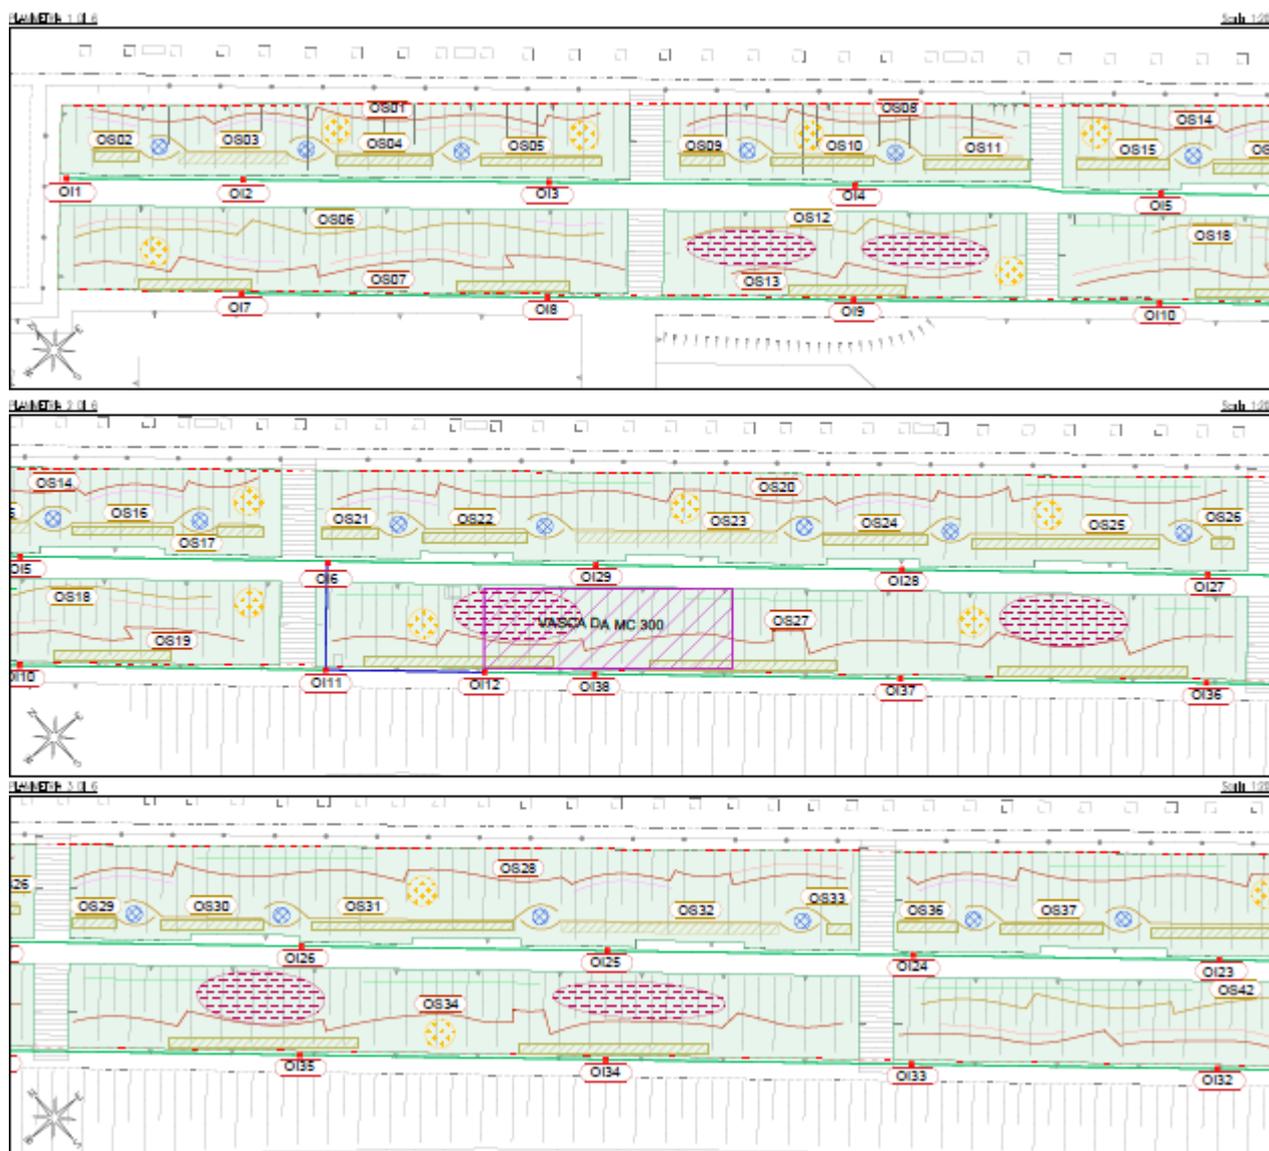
Estratto elaborato Planimetria generale di progetto (1 di 2)
